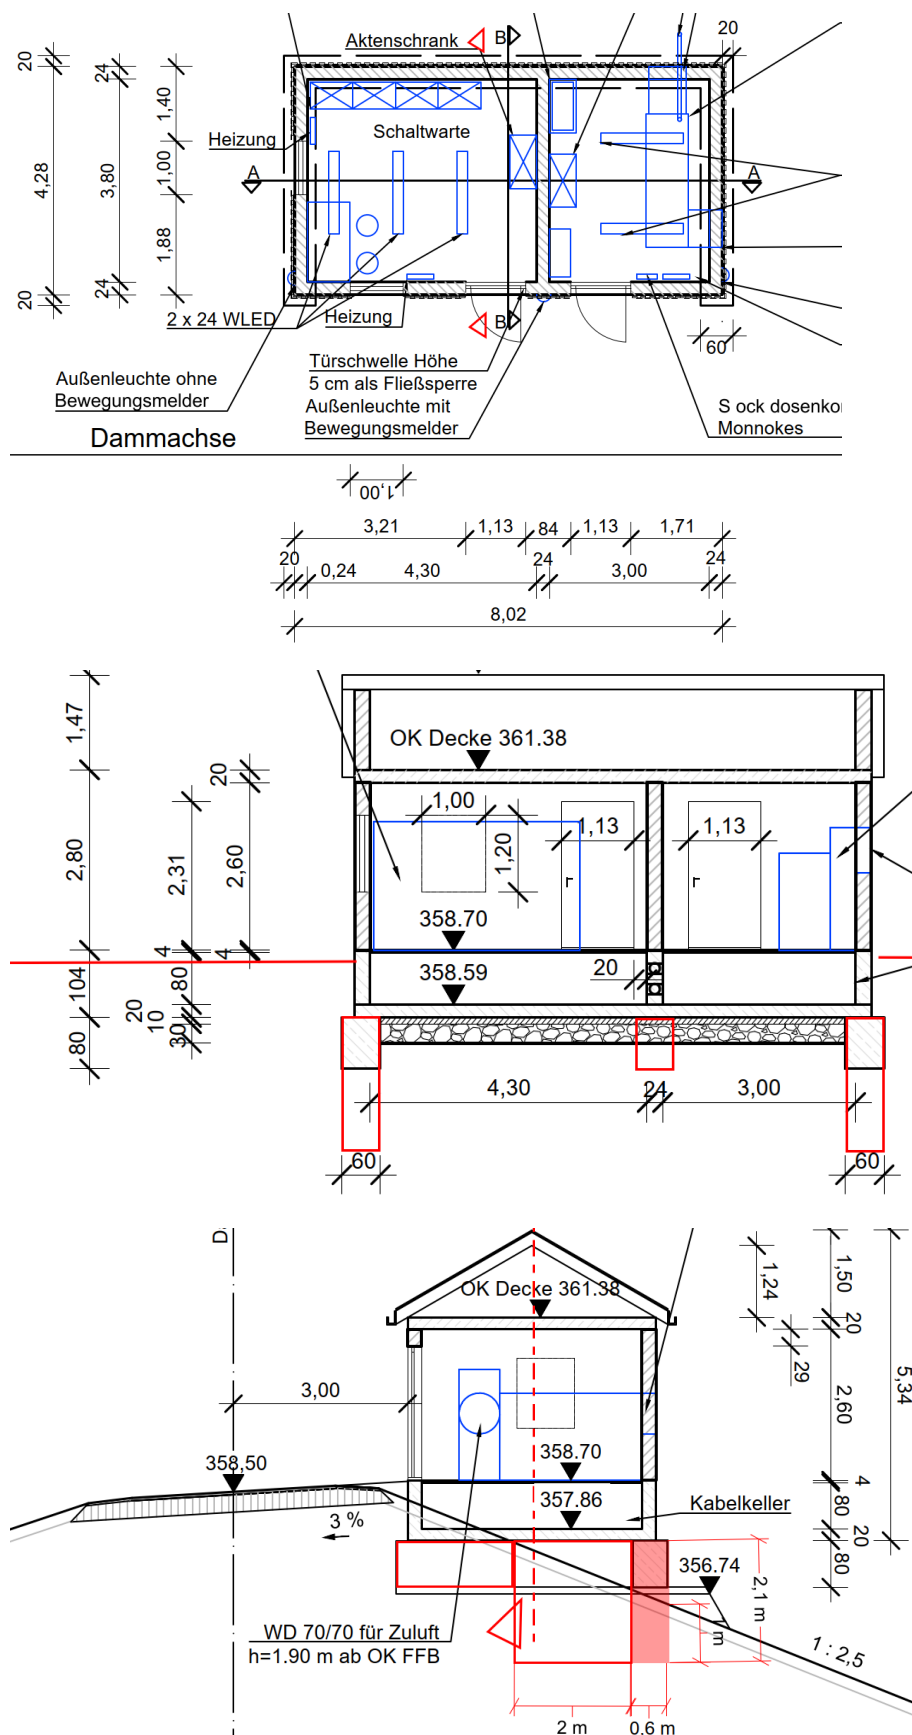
Betriebsgebäude, Grundriss, Schnitte
